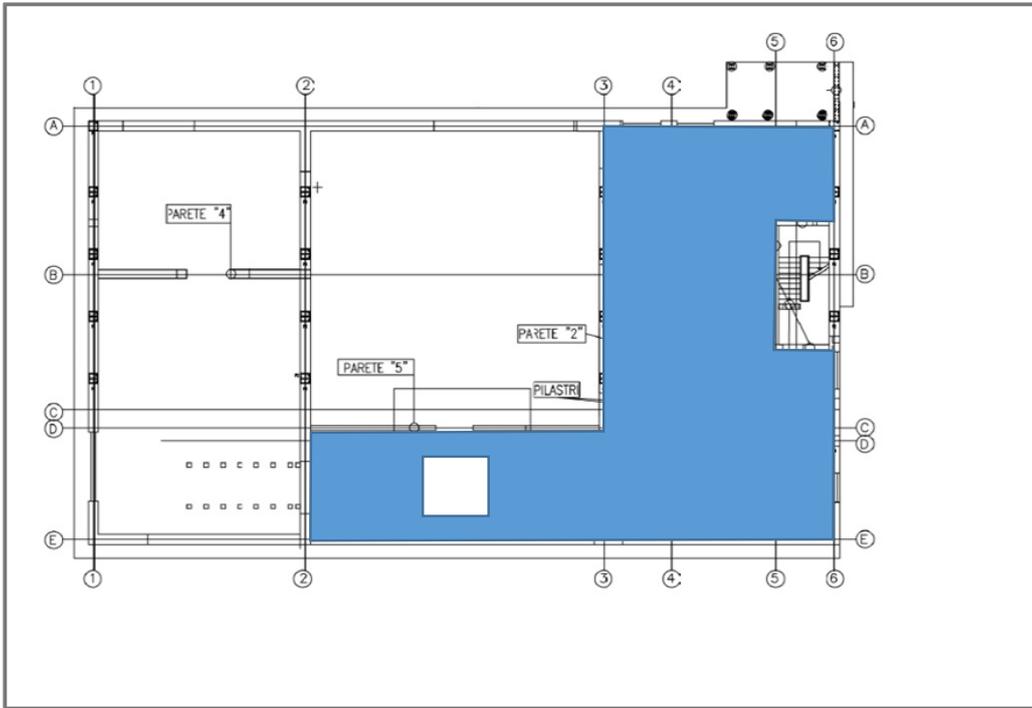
Planimetria di progetto con indicazione del solaio realizzato a quota + 5,95 di mq 423
